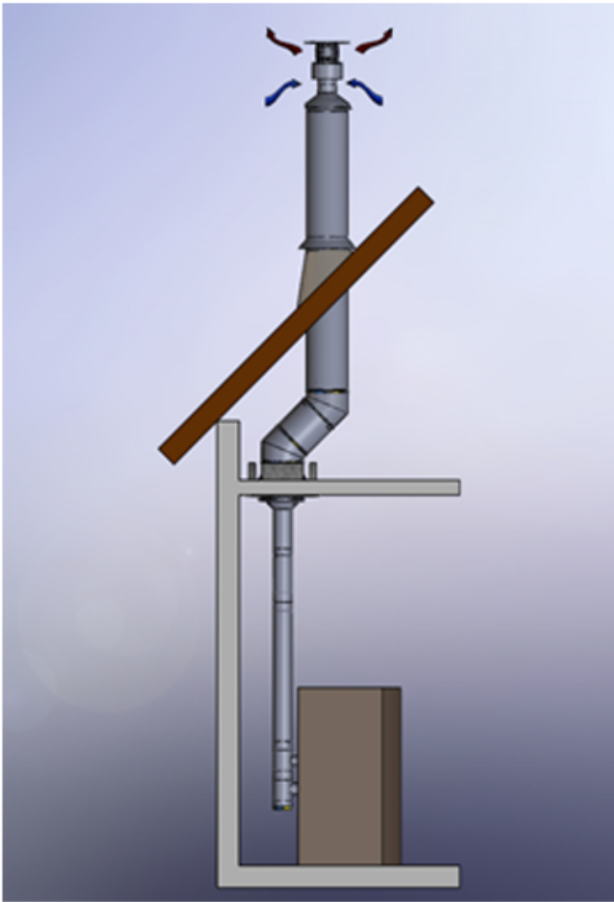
conduit flexible isolé POLYPERF équipé de la pièce d'adaptation basse plafond PLA
